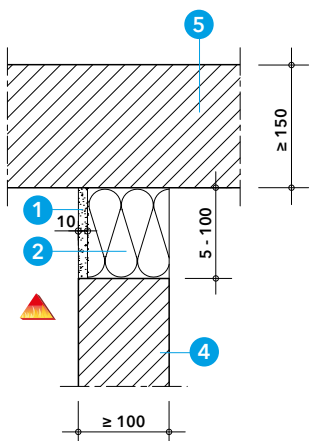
Detail H - vodorovná spára s jednostranným tmelem ve stropní konstrukci
